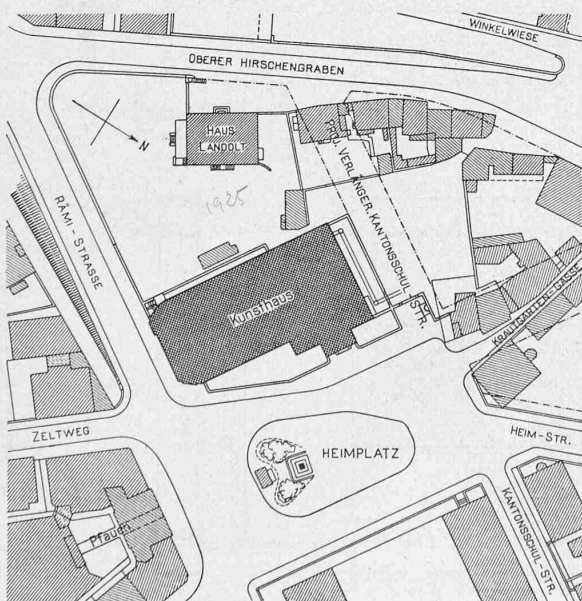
Lageplan des Zürcher Kunsthauses. — Masstab 1 : 2000.
